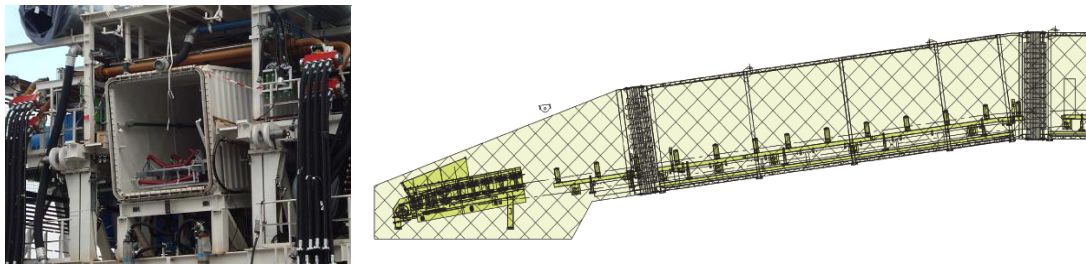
Particolare e parte della sezione longitudinale del nastro primario [15]
